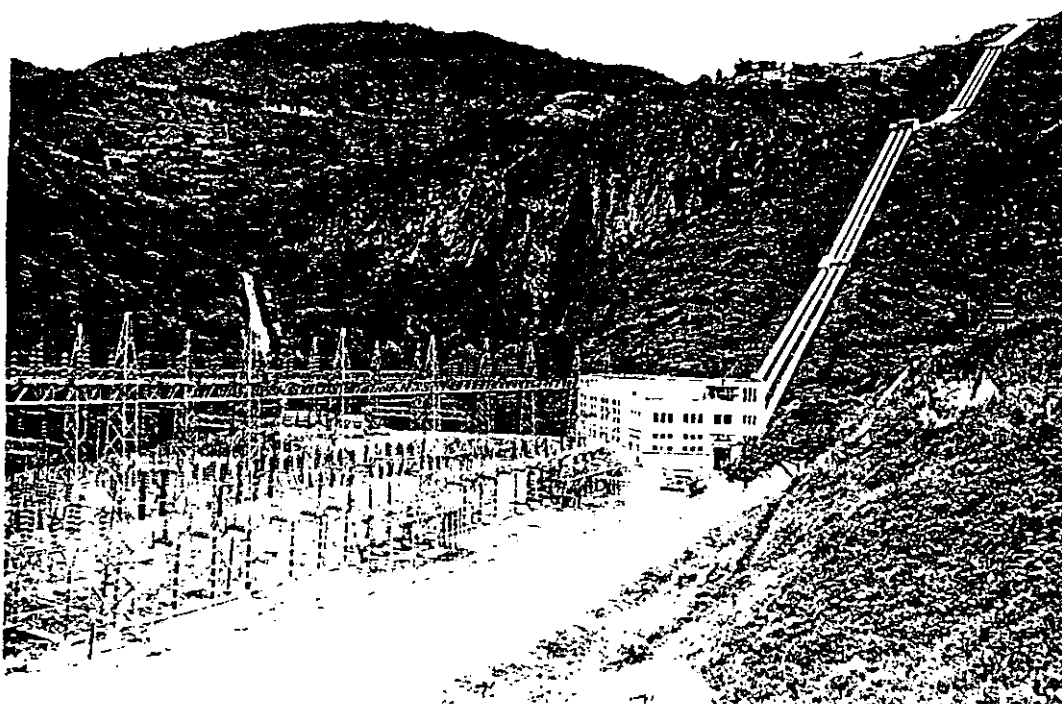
Planta Hidroeléctrica de Ixtapantongo.
